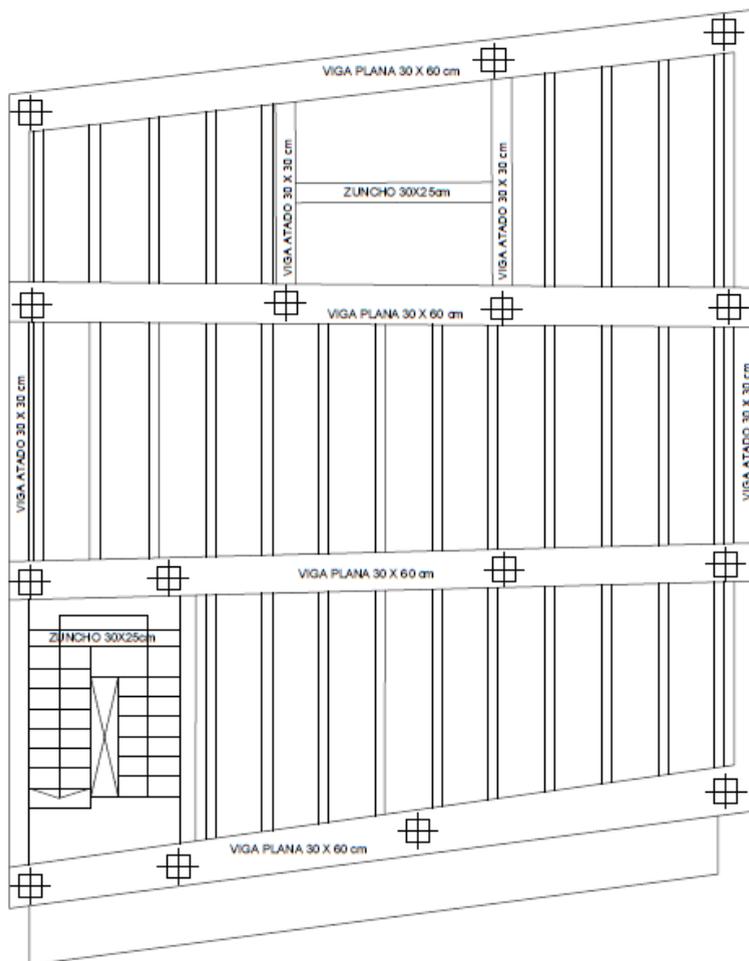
Estructura existente. Forjado 2-3-4. Fuente propia.
